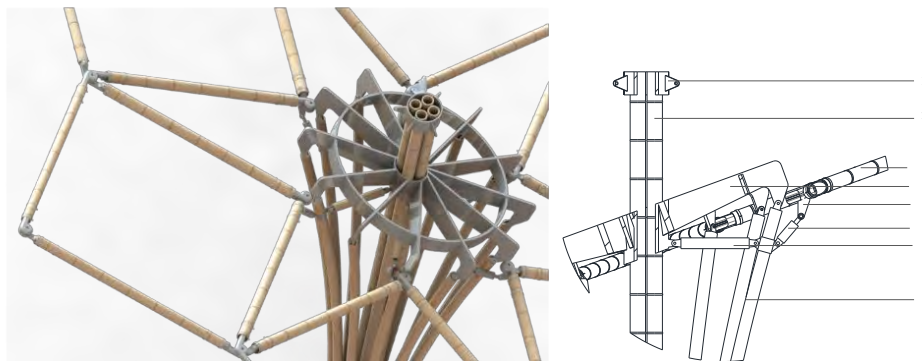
Detalle anillos de sujeción. (1) Platina anclaje tela. (2) Columna en bambú. (3) Barra de bambú. (4) Anillo en acero con platinas radiada para sostener la estructura desplegable. (5) Platina de anclaje barra de bambú cilindro hidráulico. (6) Cilindro hidráulico. (7) Barra de bambú horizontal (8) bambú perteneciente a la estructura del pilar.
